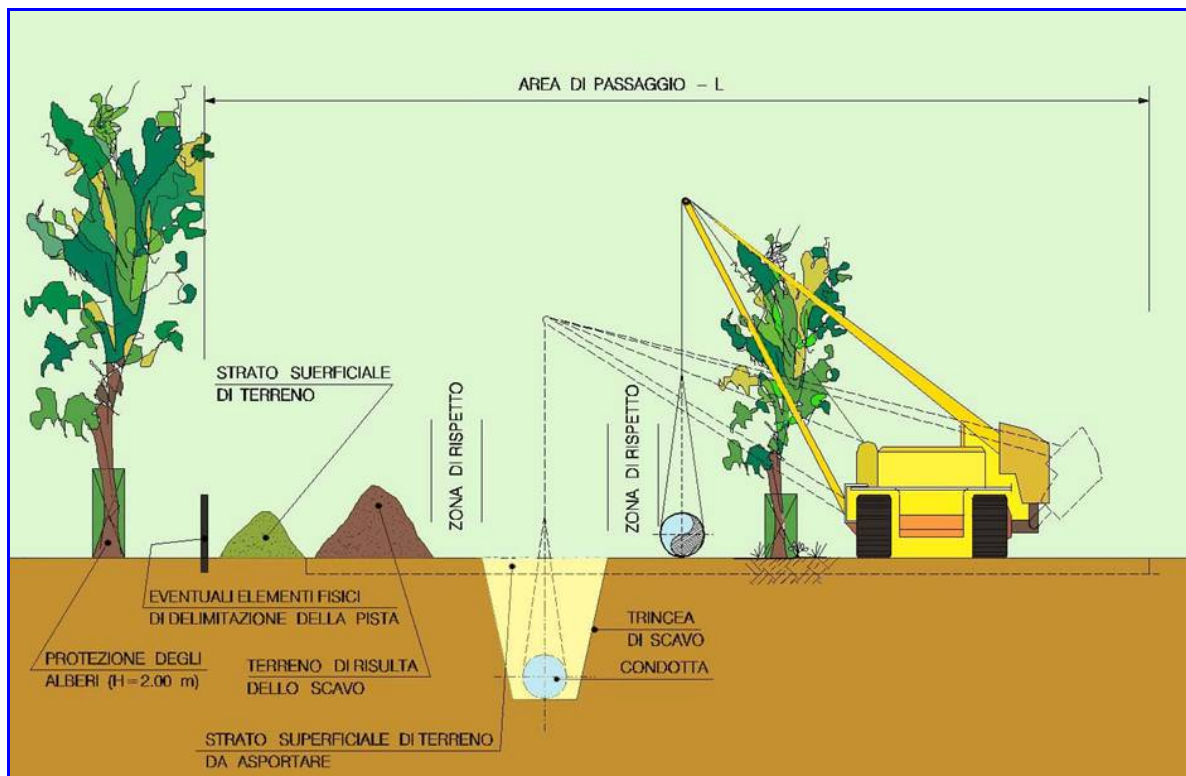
/A – Rappresentazione schematica della pista di lavoro con salvaguardia piante
